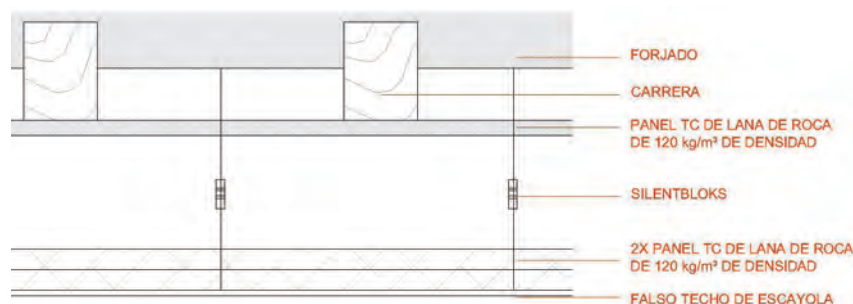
37. 1986 DETALLE CONSTRUCTIVO INSONORIZACIÓN DE TECHO EN LOCAL EN PLANTA BAJA
